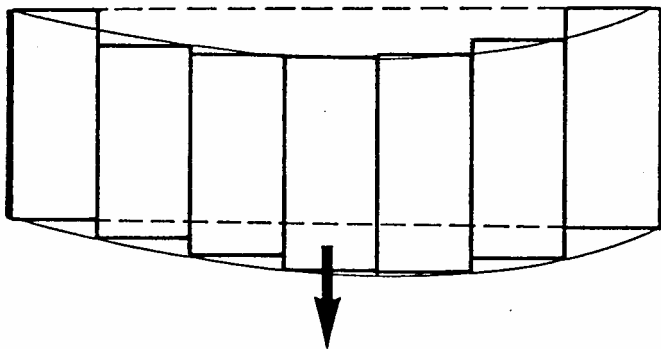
Des éléments préfabriqués disjoints n'offrent pas de raideur en plan.
